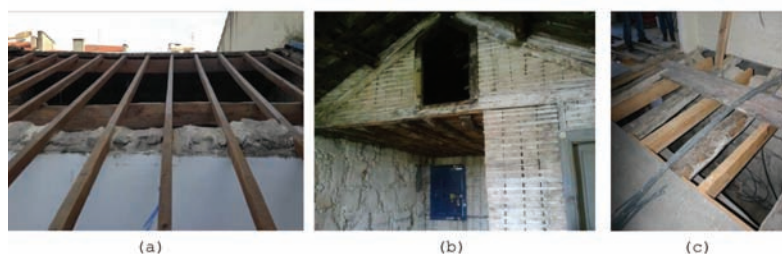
Estruturas de madeira a manter, apenas com um tratamento preventivo contra insectos xilófagos: (a) cobertura; (b) estrutura de pavimento, paredes e cobertura; (c) estrutura de pavimento, com introdução de algumas vigas novas de madeira.
